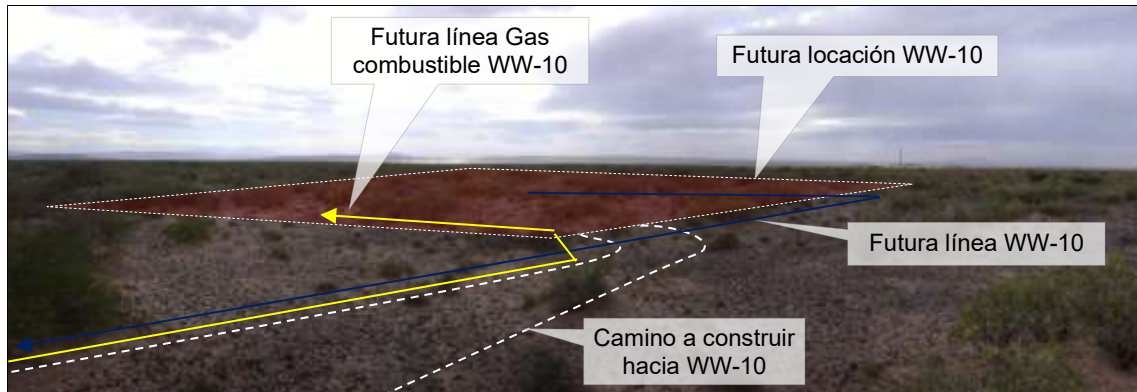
Vista en dirección Noroeste. Se observa el predio del futuro pozo WW-10 y el camino a construir sobre terreno natural para ingresar por el sector Este de la futura locación. Se aprecia en azul el inicio de la traza de la línea WW-10 y en amarillo el tramo final de la futura línea gas combustible WW-10; ambas líneas se ubican paralelas al futuro camino de acceso. Coordenadas x: 5832984; y: 2487830.
